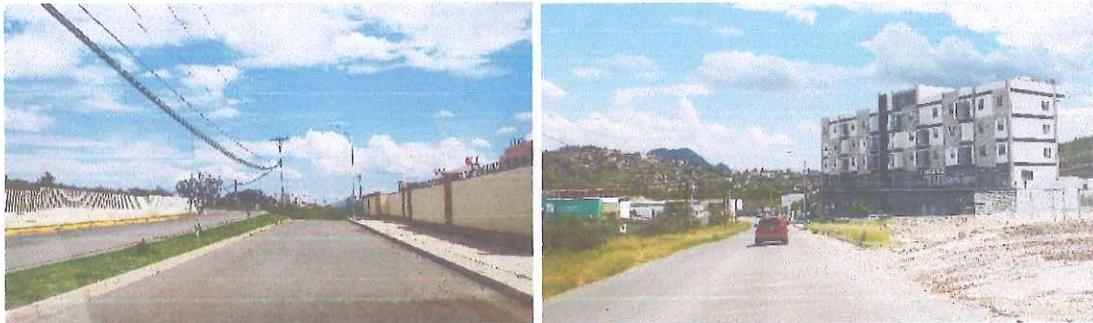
Sección vial propuesta e imagen de la Av. Pedro Zuloaga.
